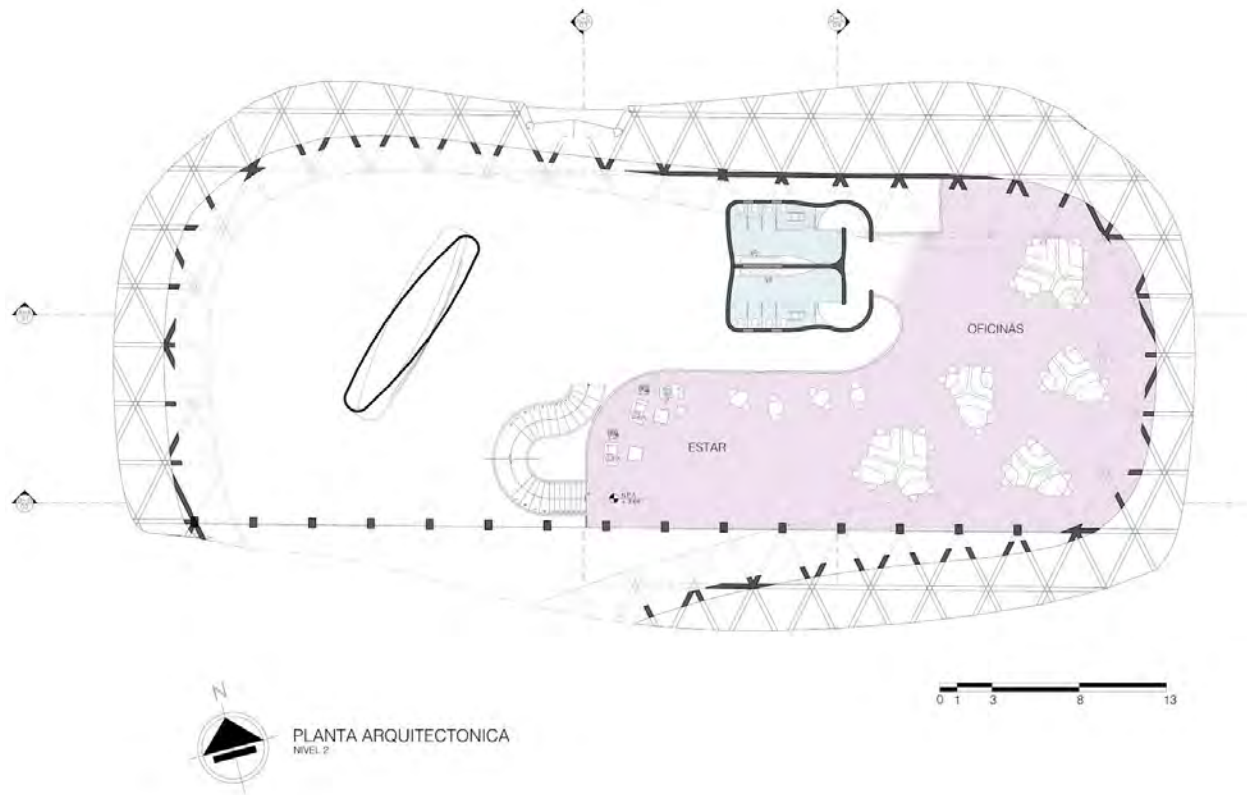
Planta arquitectónica, segundo nivel. Elaboración propia.
